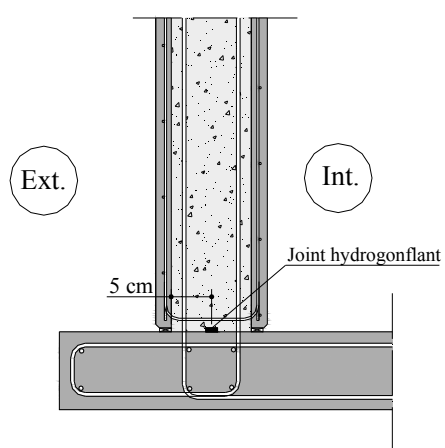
Etanchéité d'un mur d'épaisseur 30 cm
